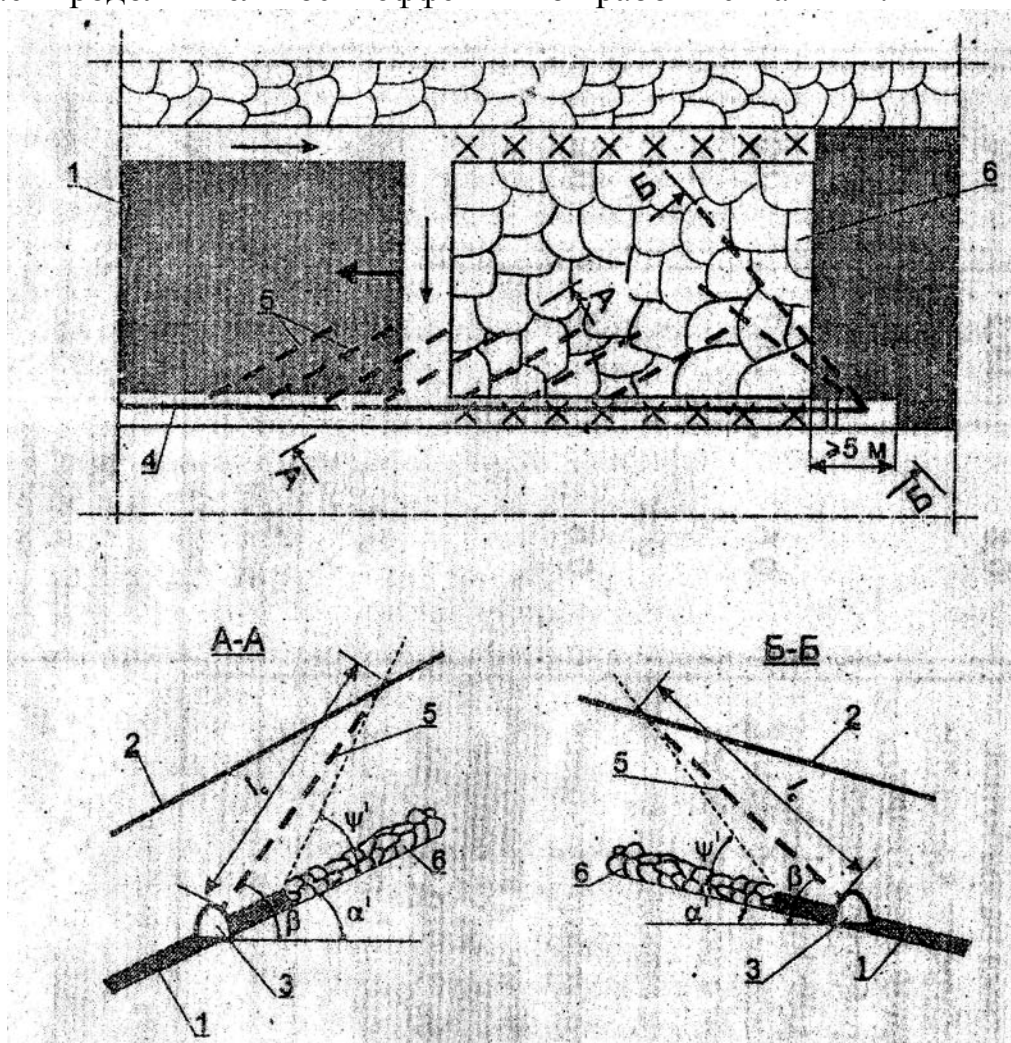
Схема дегазации подрабатываемого пласта скважинами, пробуренными навстречу очистному забою и над монтажной выработкой: 1 – разрабатываемый пласт; 2 – подрабатываемый пласт; 3 – вентиляционный штрек; 4 – газопровод; 5 – дегазационная скважина; 6 – выработанное пространство; l_c – длина скважины; ψ и α' – проекции углов разгрузки пород
